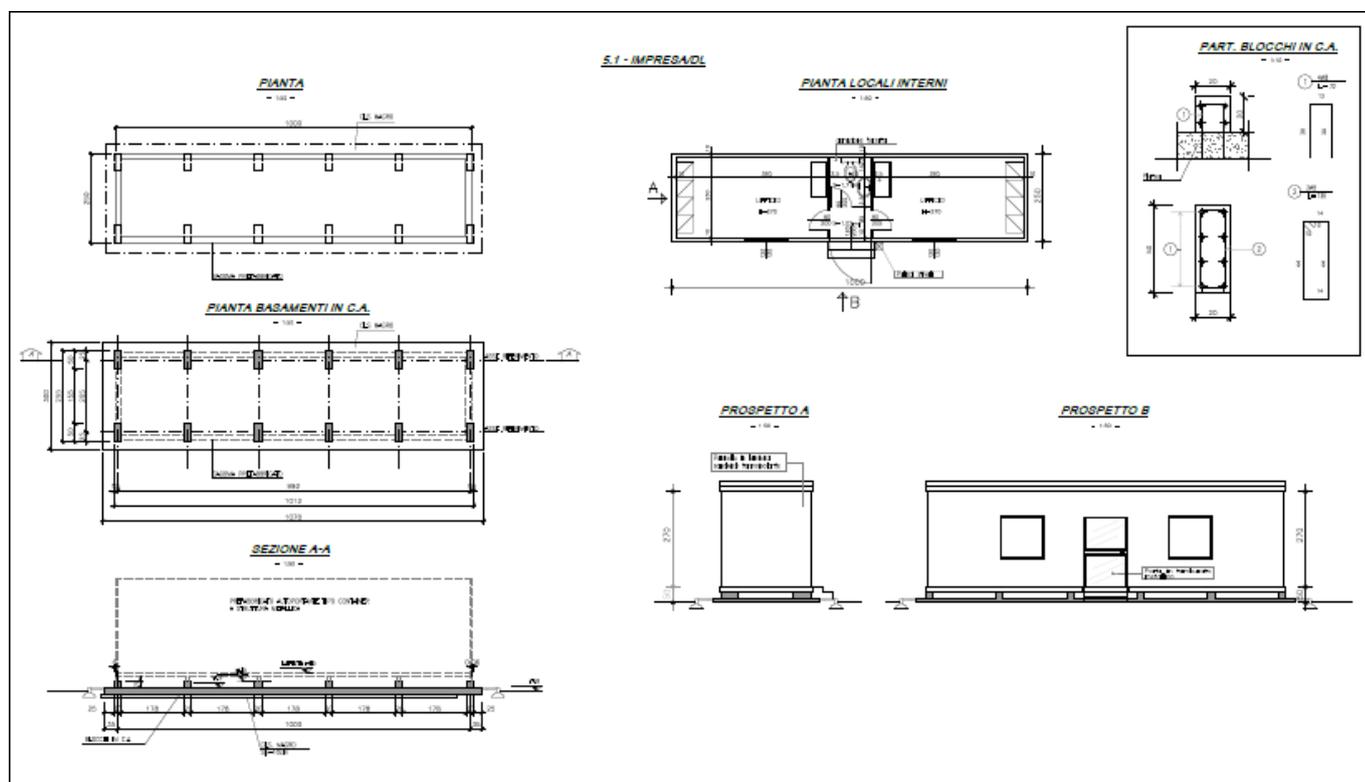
Dettaglio tipo prefabbricato uso uffici
